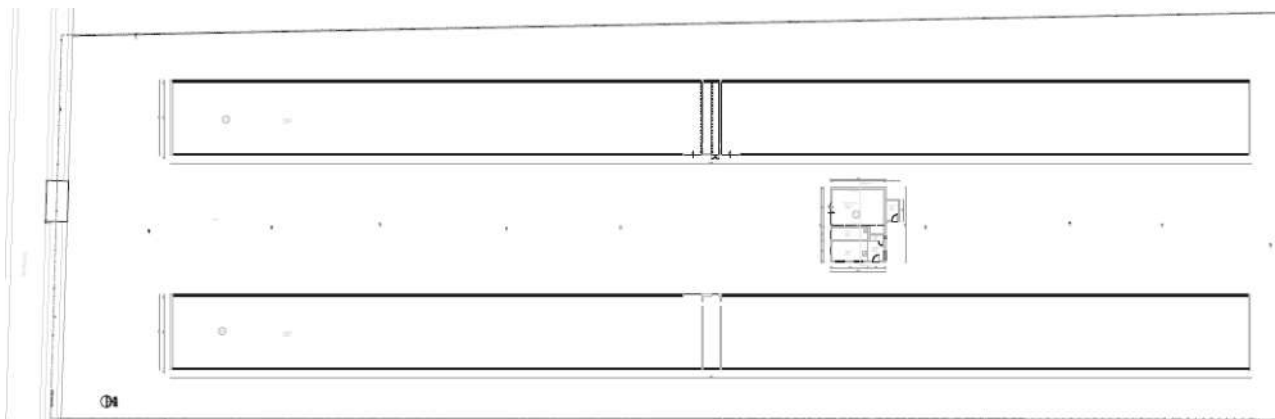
estratto dal rilievo planimetrico dell'area di studio
